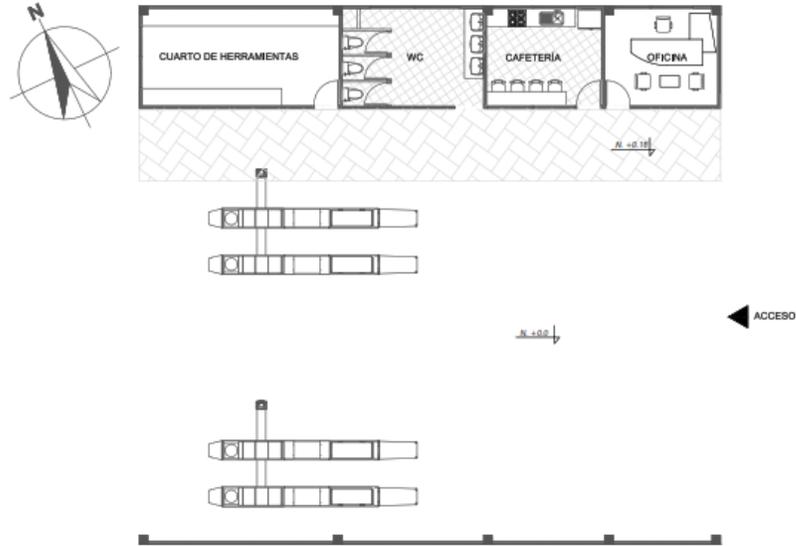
PLANTA ARQUITECTÓNICA EQUIPAMIENTO
